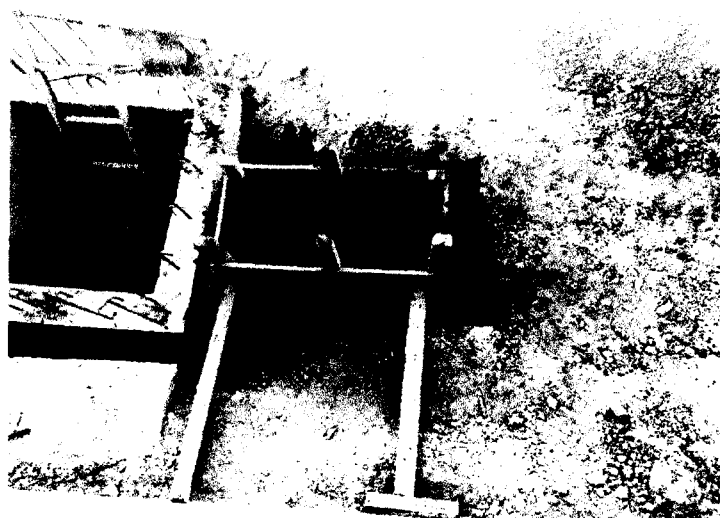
Se realizan los trabajos de encofrado para cámara de bombeo N° 03.
